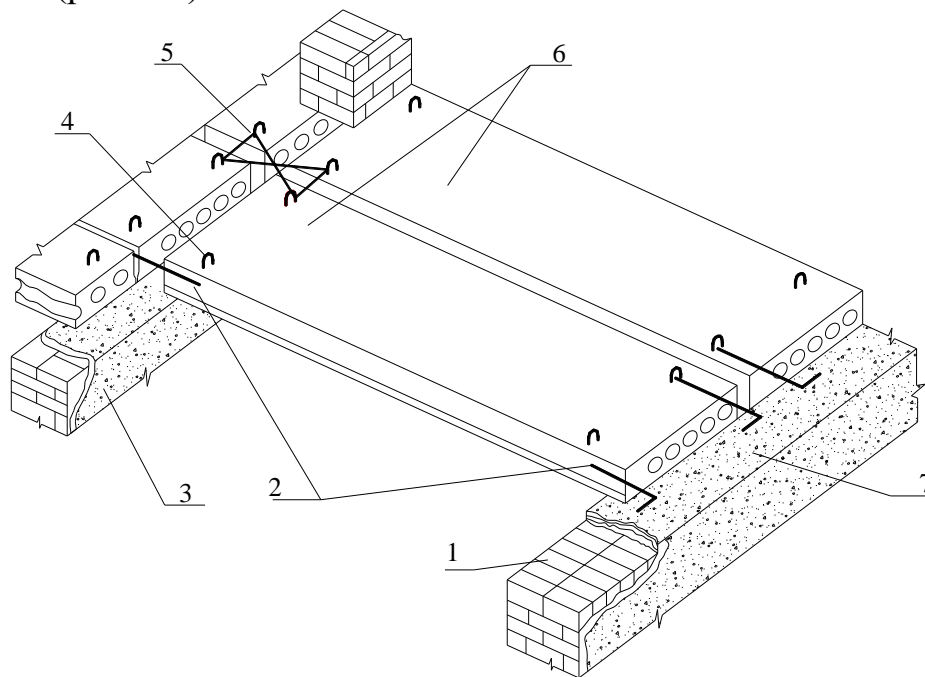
Міжповерхове перекриття по залізобетонних панелях:
